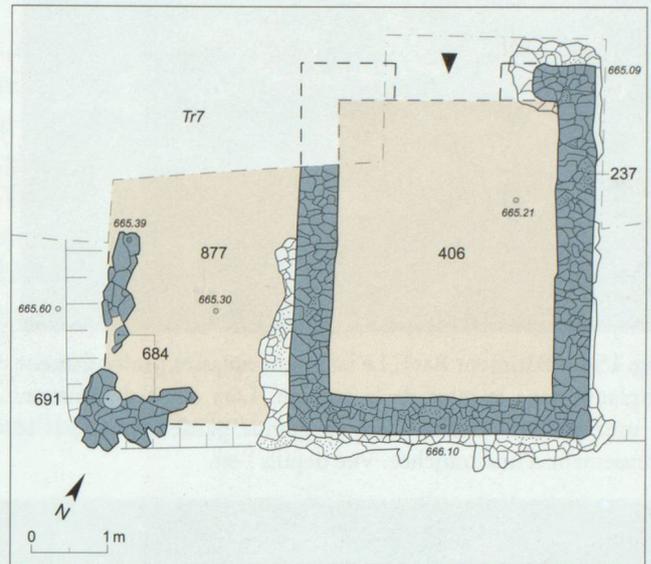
Bâtiment Bat1 (II^e-VIII^e s.). Plan pierre à pierre du bâtiment avec son annexe du côté ouest.
